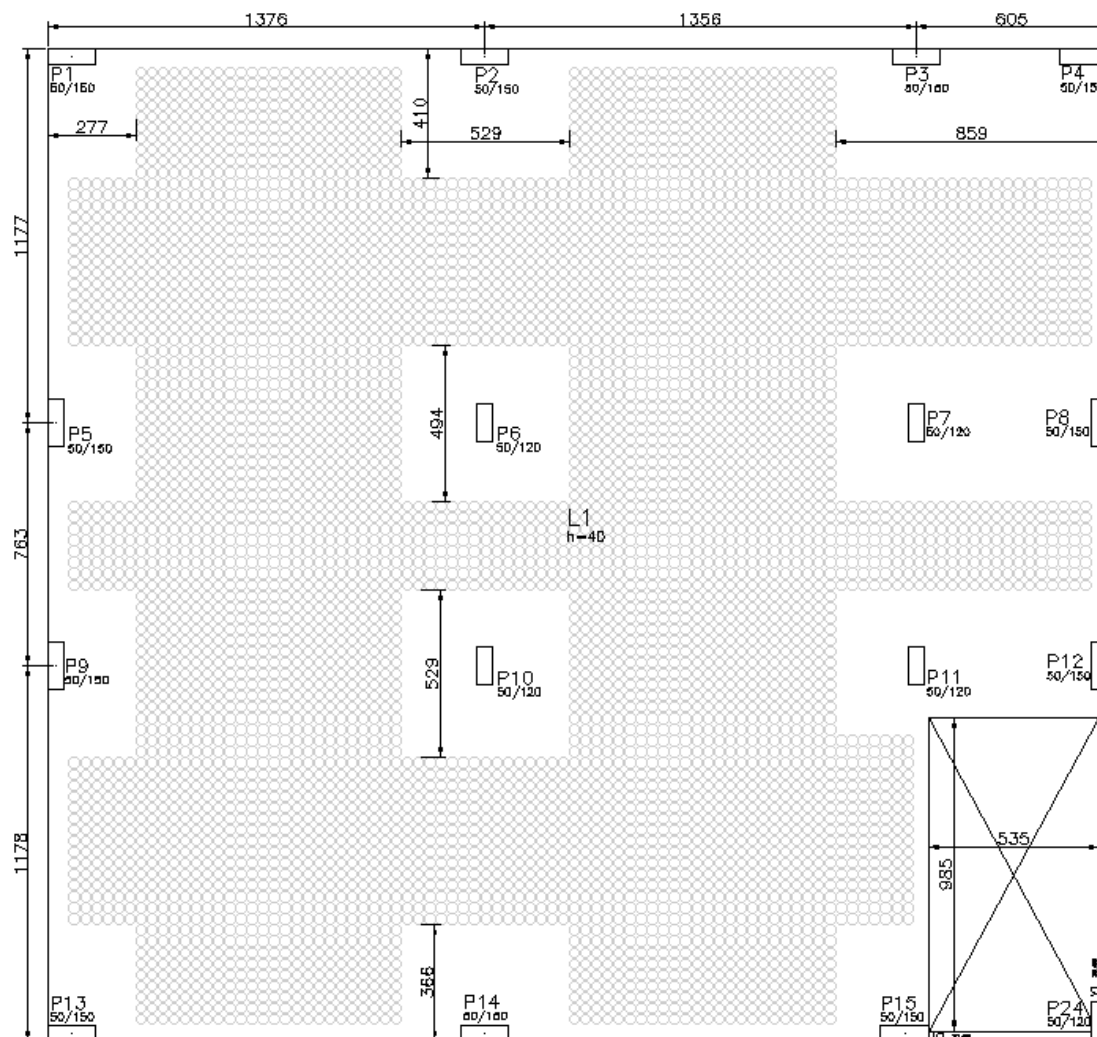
Projeto C3 - Planta de forma (dimensões em cm).
